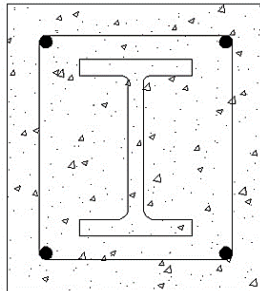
2 Balok Baja yang Diberi Selubung Beton
